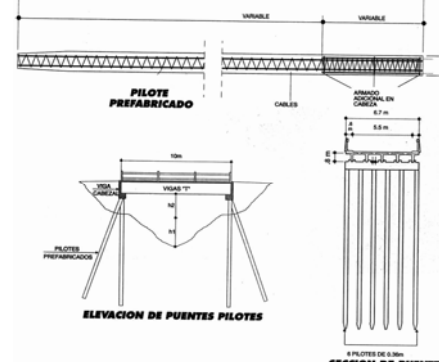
Pilotes de concreto. Fuente: empresa PRECON
